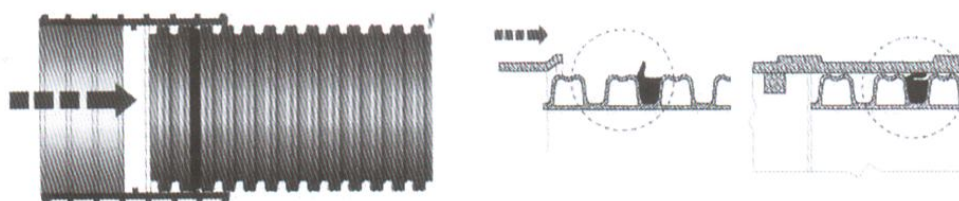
Установка уплотнительного кольца для труб 110–200 мм
